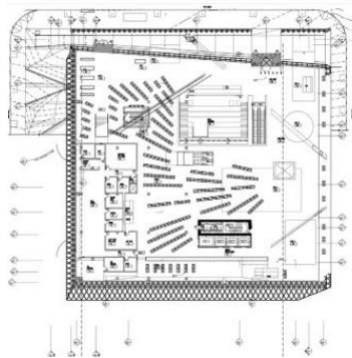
Planta da Biblioteca Central de Seattle
